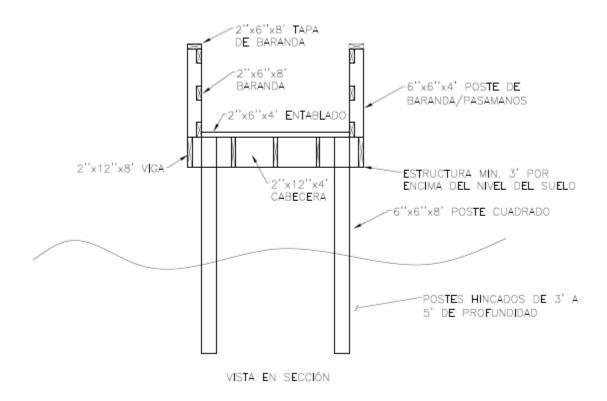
Vista típica de la sección de paseo tablado por las dunas
